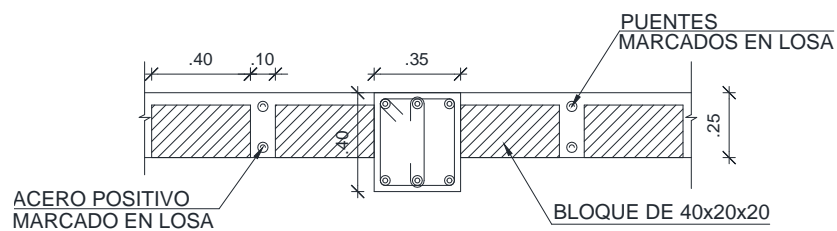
Diseño Etabs v15.2 y corte transversal losa. Segunda alternativa.
